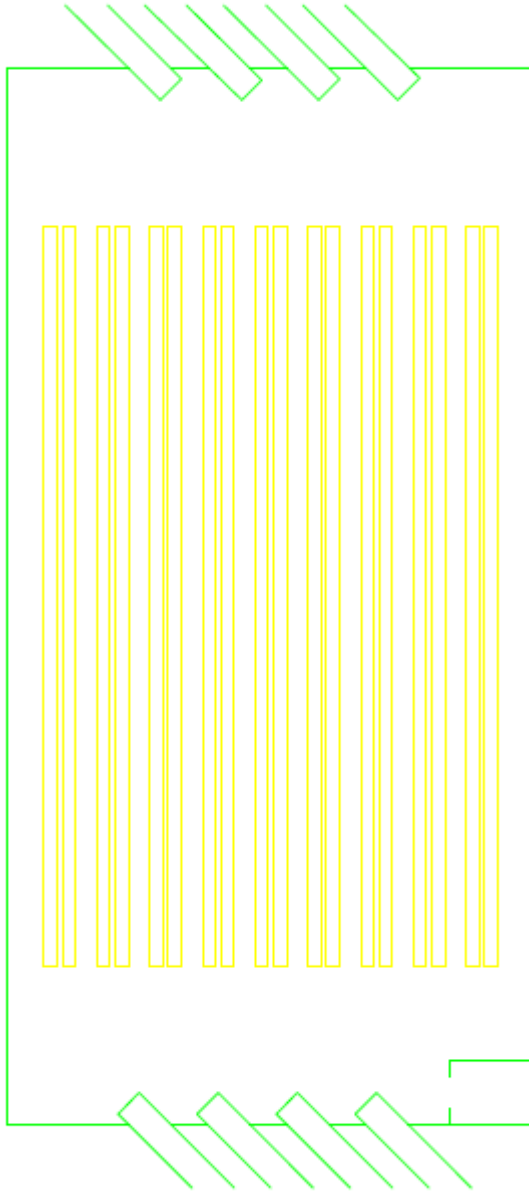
Plano de planta de una de las naves del almacén (Barcelona, 2014) Elaboración propia
